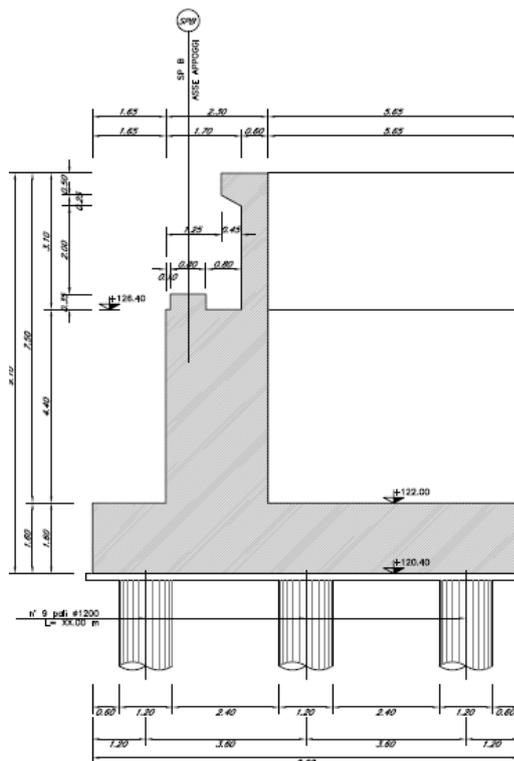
carpenteria spalle: sezione trasversale
